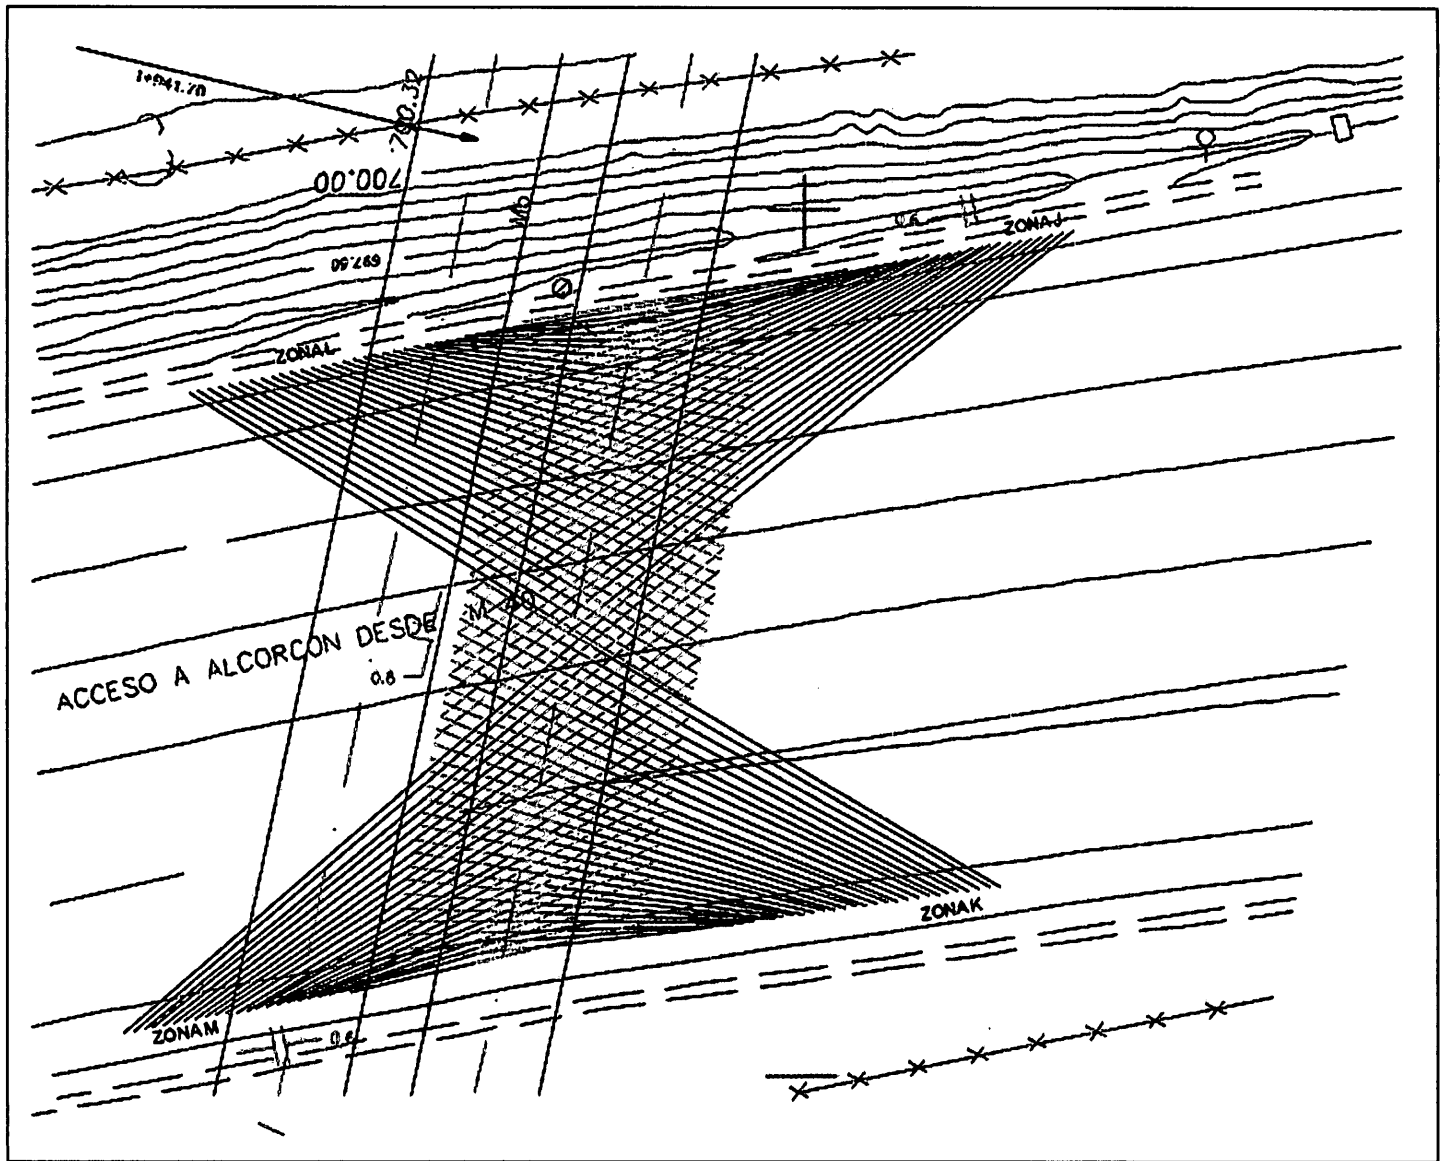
Tratamiento con jet-grouting en el cruce con el acceso a la M-40, Túnel 4 de la ampliación de la Línea 10 Tramo 2 (Planta).
